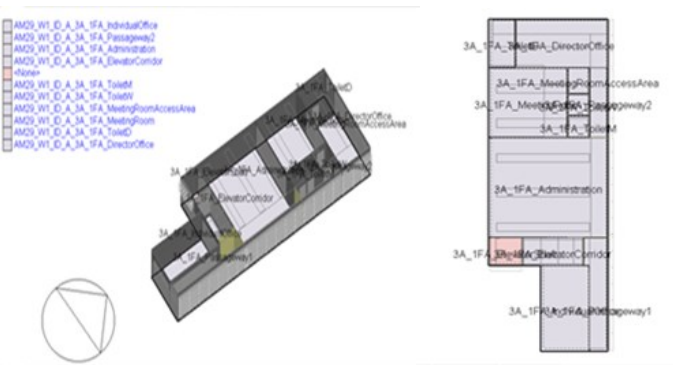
Modelo en Design Builder de la primera planta. Fuente: Modelo facilitado por la empresa.
